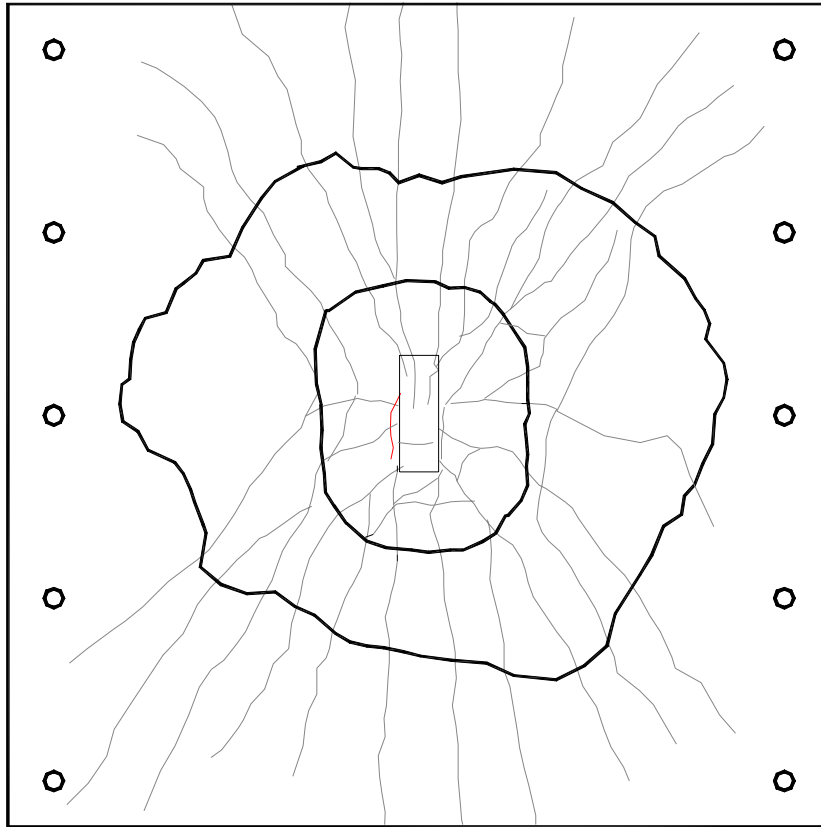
Mapa de fissuração da laje L2A
